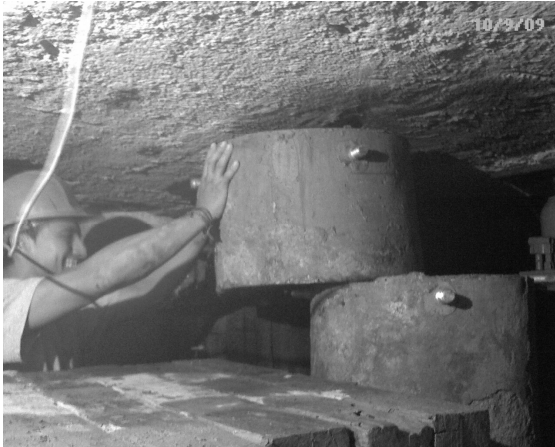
Extracción de un segmento de pilote en zapatas tipo Z-1. Obsérvese como no hay daño en las piezas y una sola persona la puede mover.
